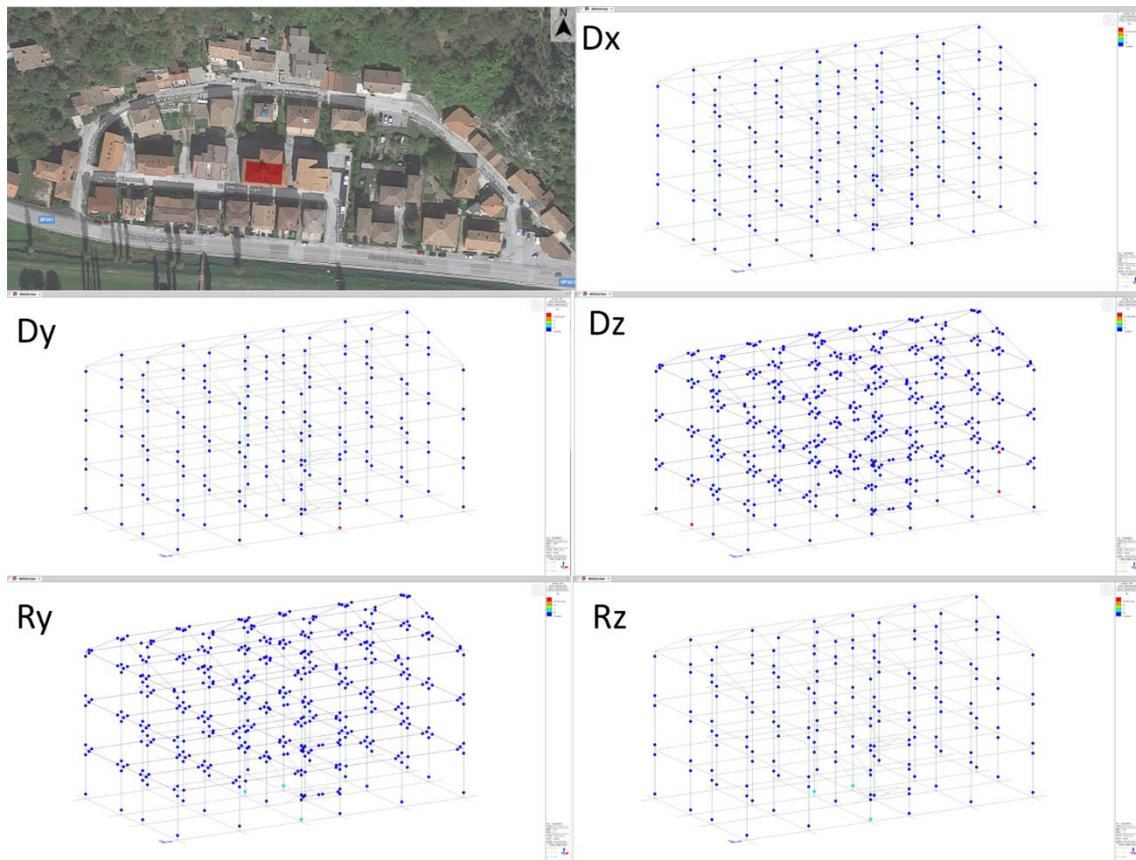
Cedimento fondale applicato ad un edificio in c.a. a tre piani con trave rovescia nella POSIZIONE 2 all'interno del quartiere "Madonnetta" del comune di Pioraco.
